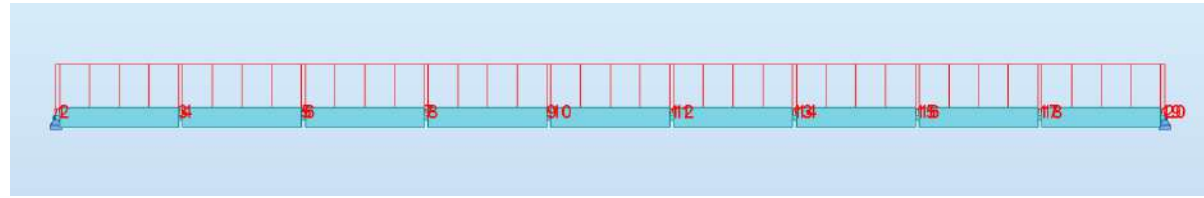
Modelo simplificado sección transversal de la cubierta.
